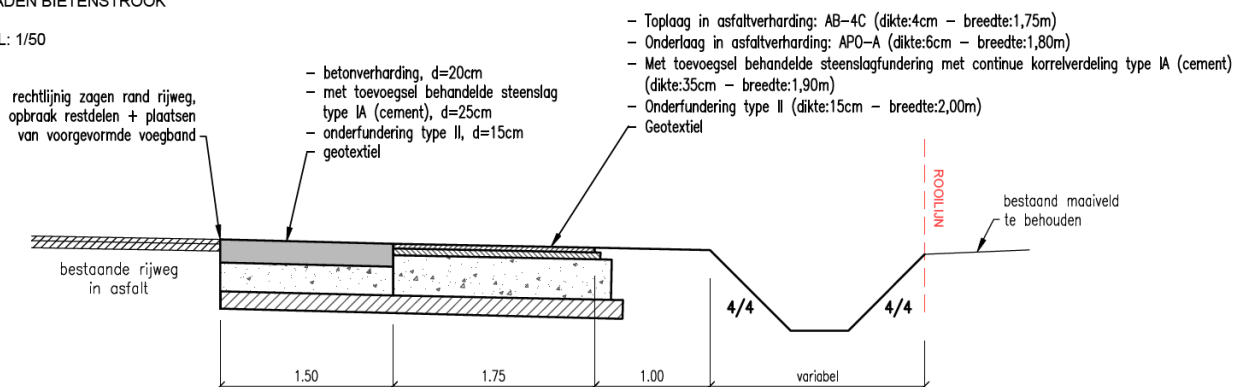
Typeprofiel bij tussenstrookverharding ifv laden bieten
